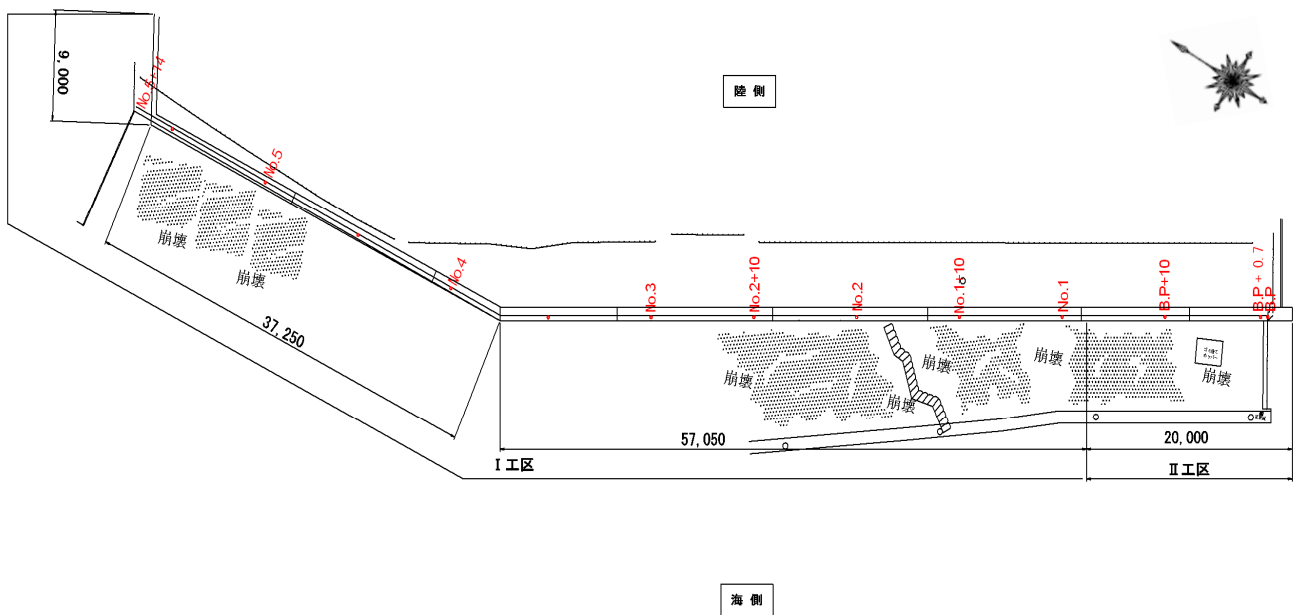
No.5 池向岸壁の平面図（被災後）
